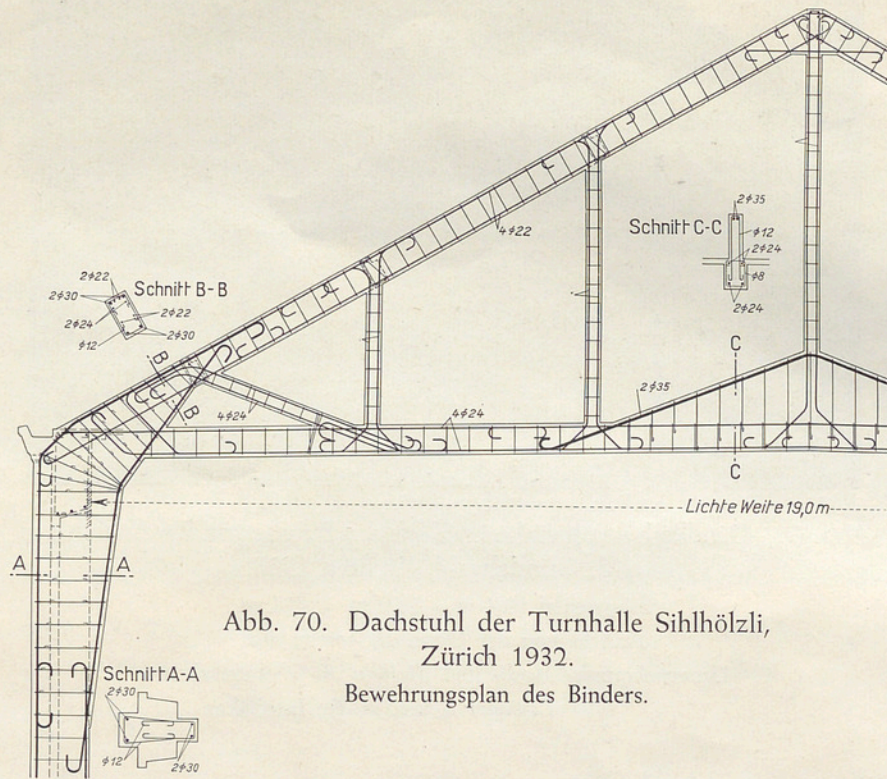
Dachstuhl der Turnhalle Sihlhölzli,
